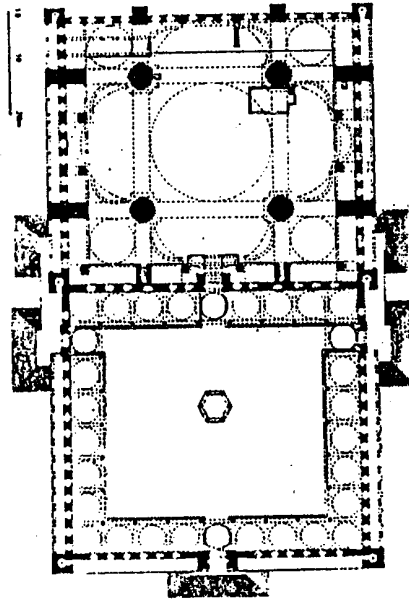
مسقط أفقي للجامع الكبير في البستان بجنوب الاناضول
